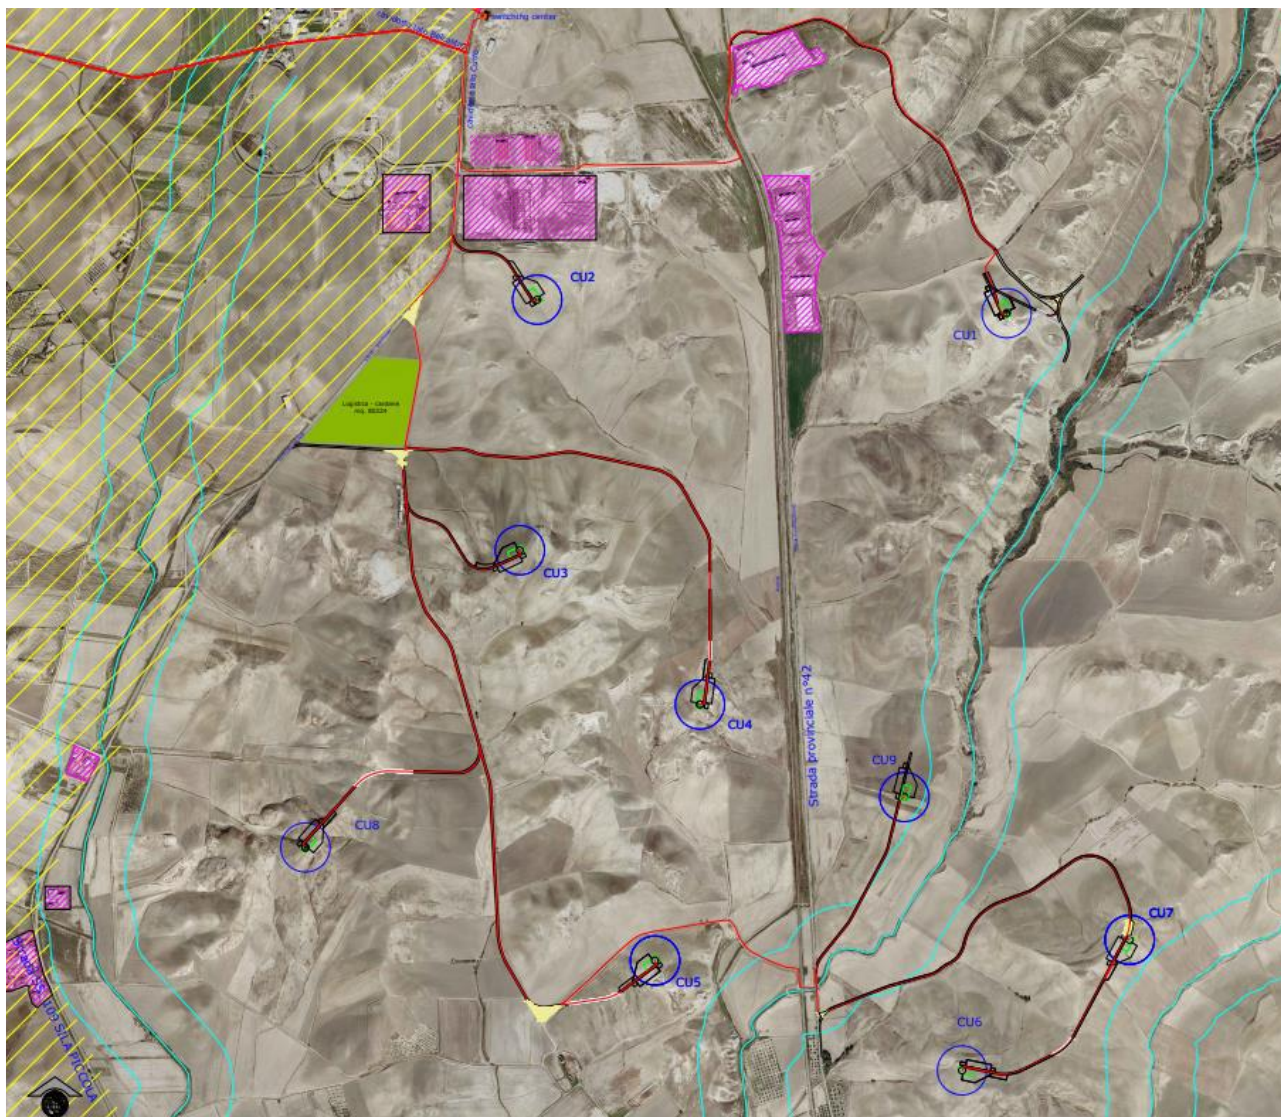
Layout di impianto lato Cutro su base ortofoto
